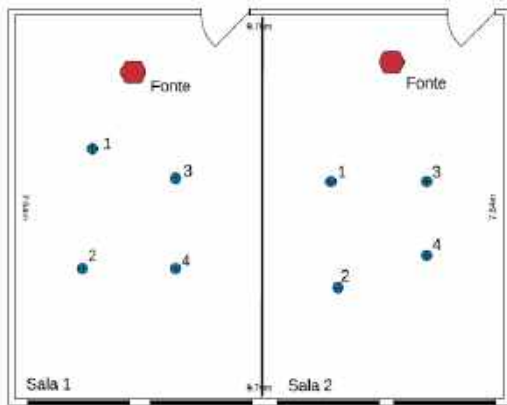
Planta baixa, com indicação do posicionamento da fonte e receptores, das Salas 1 e 2, separadas por uma parede lateral removível. (Os autores, 2018).
